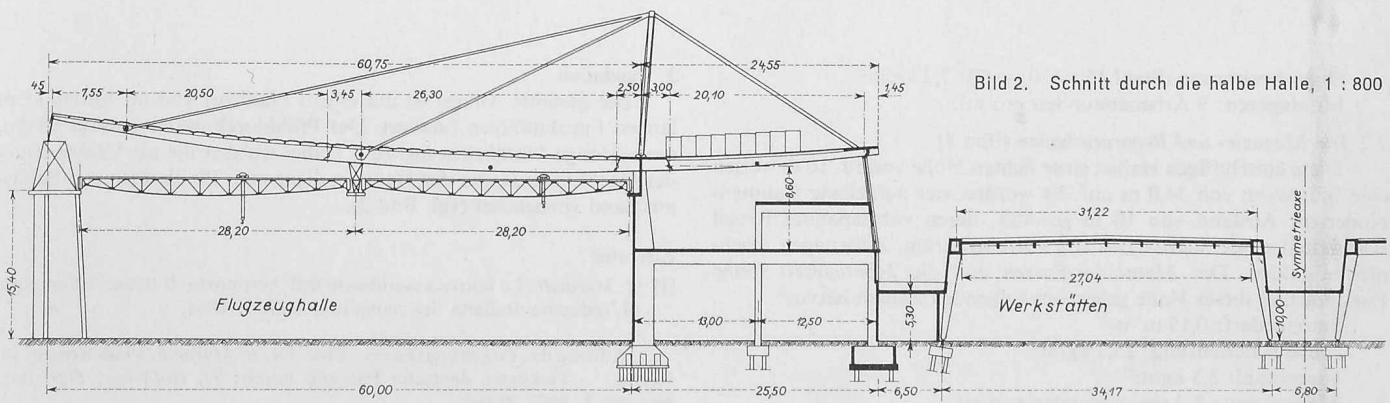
Schnitt durch die halbe Halle, 1 : 800
